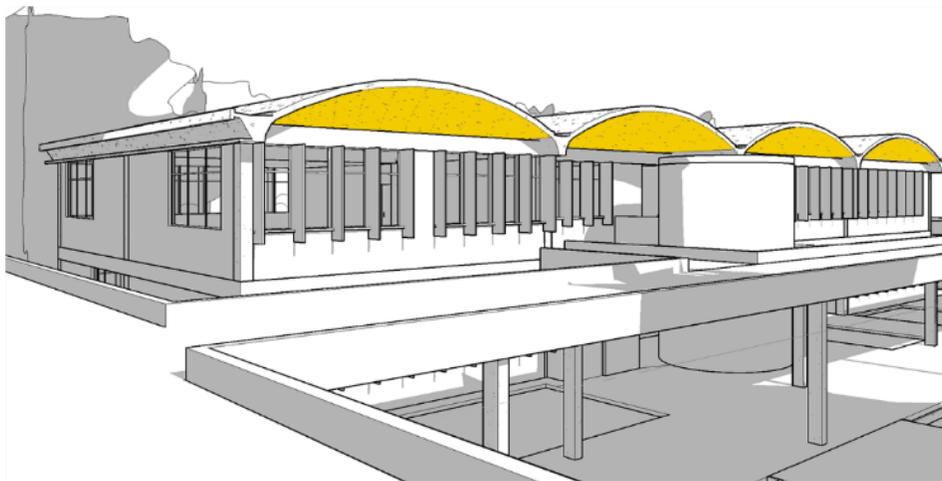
Ventilación Cruzada 1. Modelado BIM.
